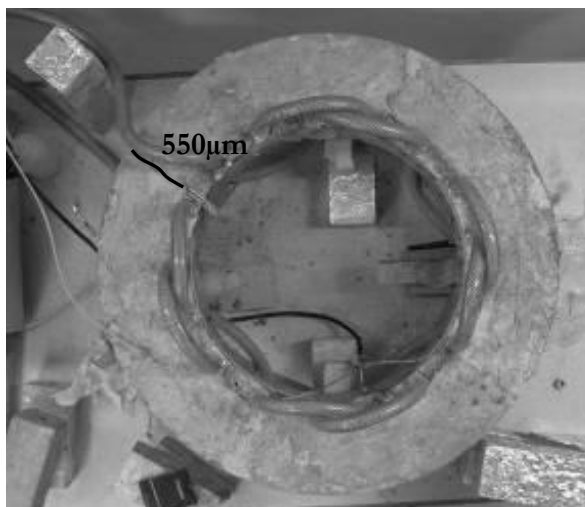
Faciès de fissuration de l'anneau avec reprise de bétonnage
